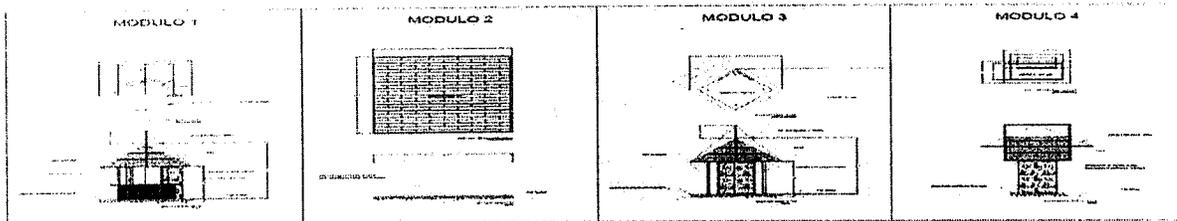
Plantas arquitectónicas y fachadas del proyecto "Módulos Multifuncionales en Playa".
